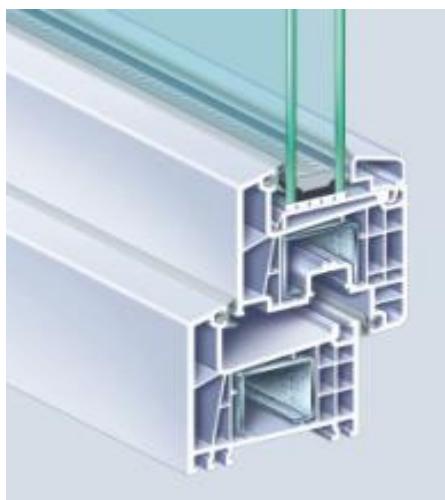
Профиль однокамерного стеклопакета со стальными вкладышами [8]
